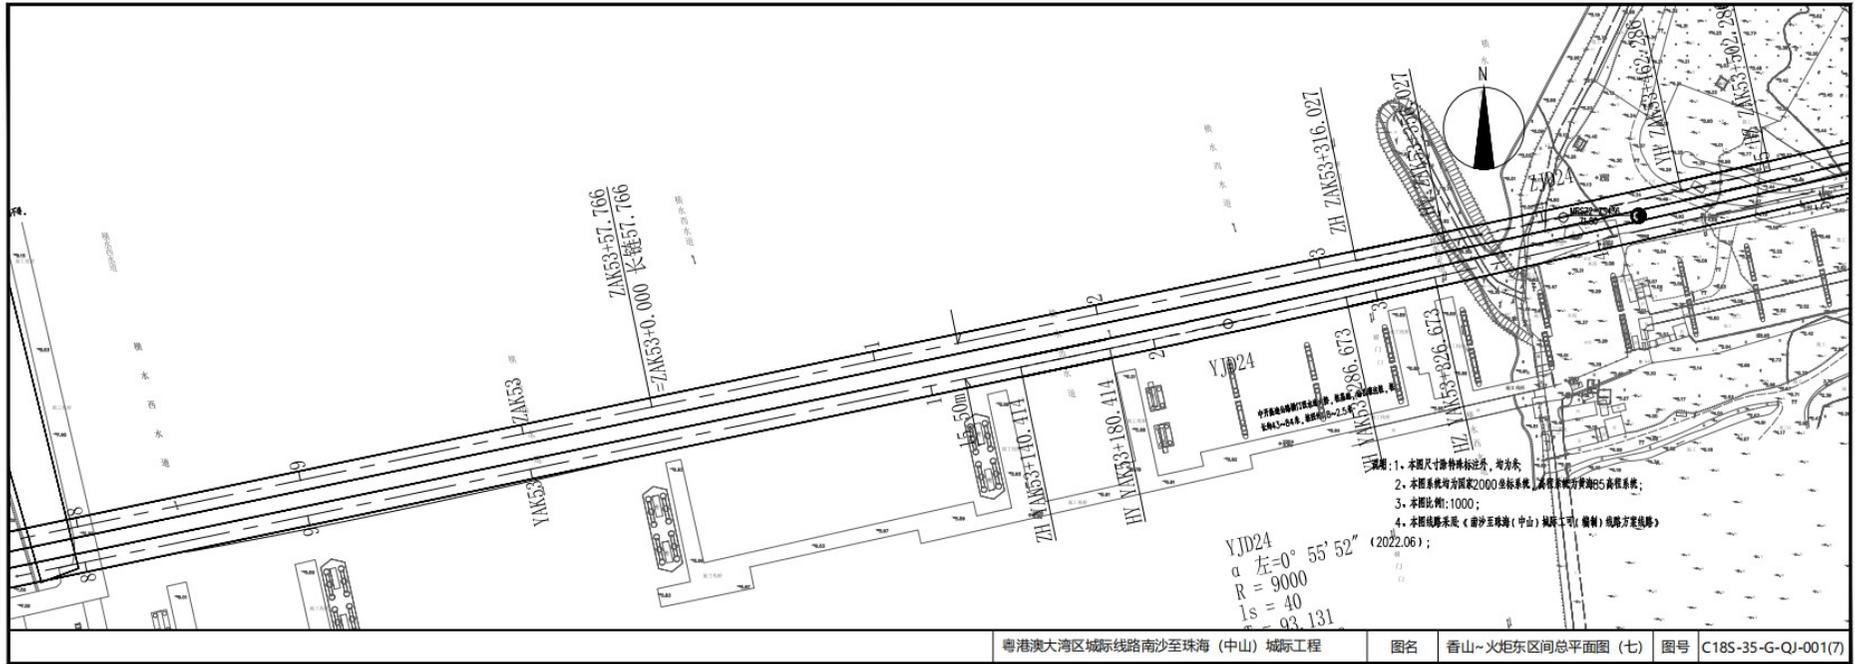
线路平面图（香山至火炬东站涉海工程段）
